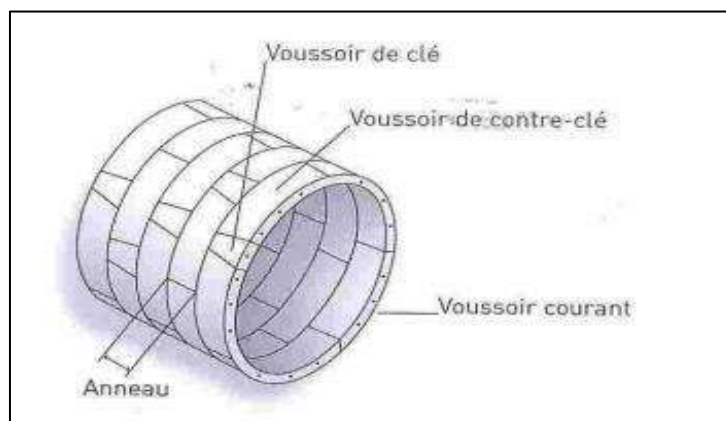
le revêtement en voussoirs préfabriqués. [20]
